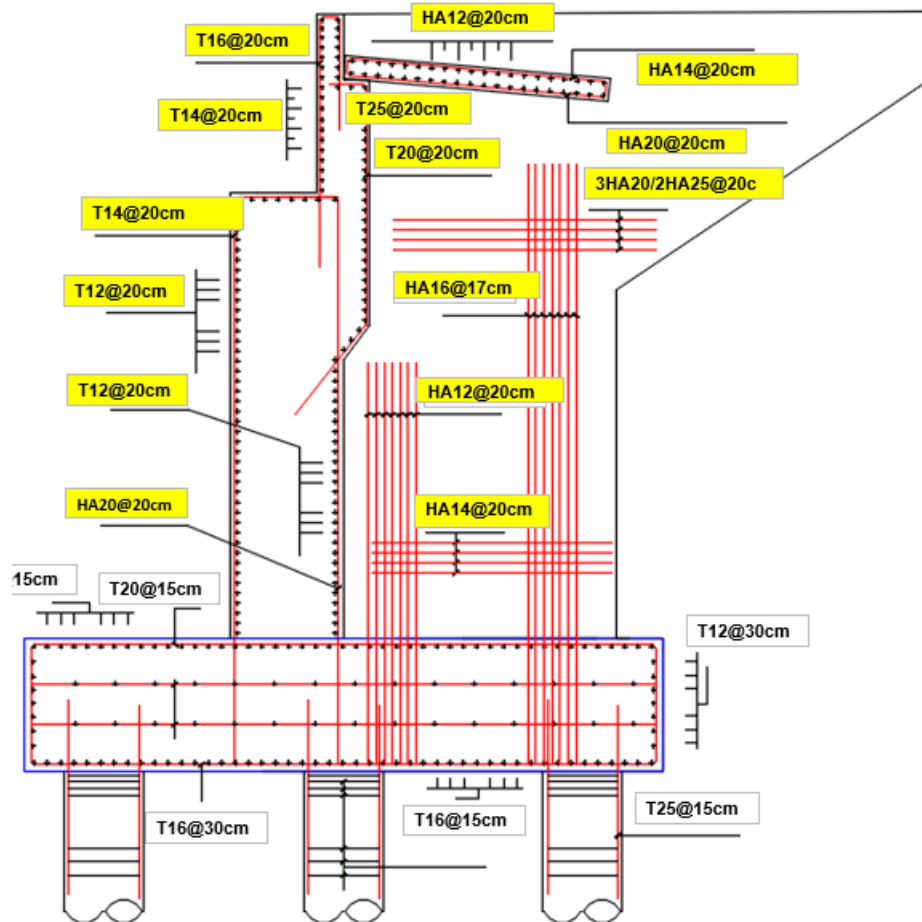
Croquis de ferrailage des éléments de la culée.
